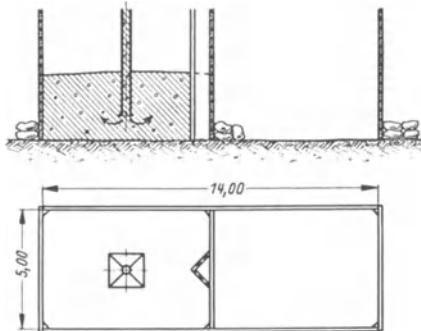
Durchführung von Unterwasserbeton nach dem Kontraktorverfahren. Der Beton wird in einen Trichter eingefüllt und verdrängt das Wasser aus der Schalung allmählich nach oben, nur die oberste Betonschicht kommt mit dem Wasser in Berührung.
